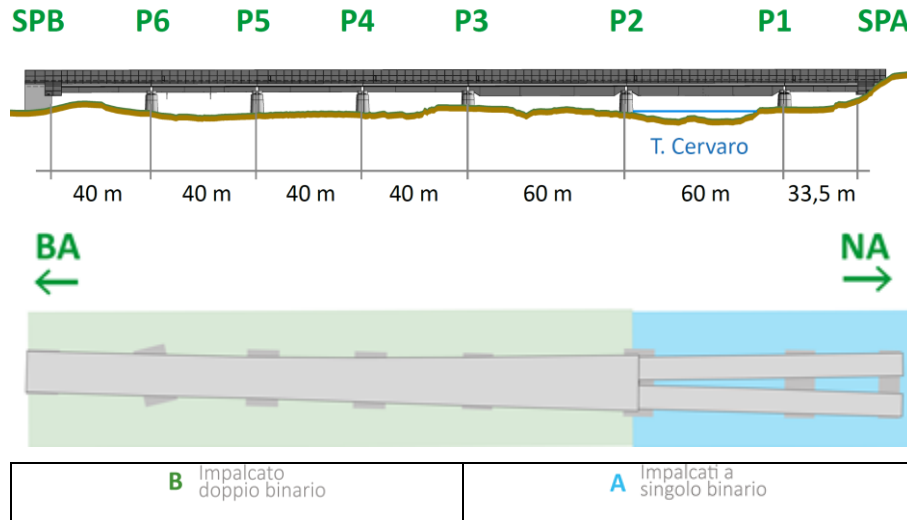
Profilo e schema planimetrico viadotto Cervaro, con la individuazione delle tratte A e B a singolo e doppio binario.
